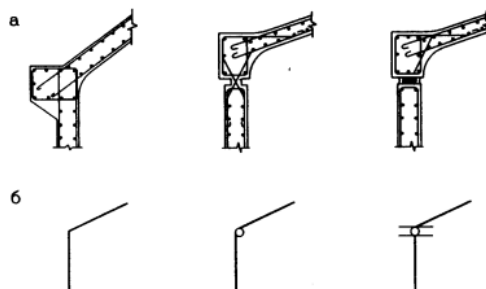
Узлы сопряжения стен с пространственными конструкциями покрытий резервуаров.
